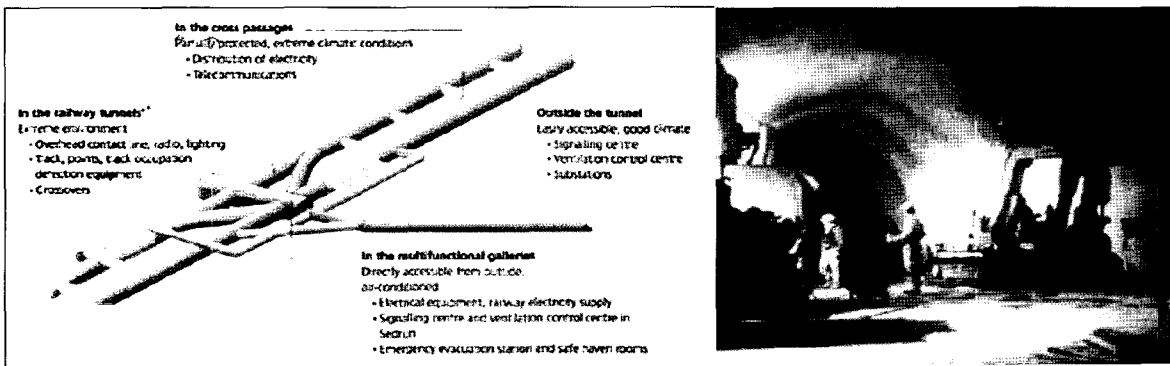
세계 최장대 터널(시공중) - Gottahard Base Tunnel(57km)
